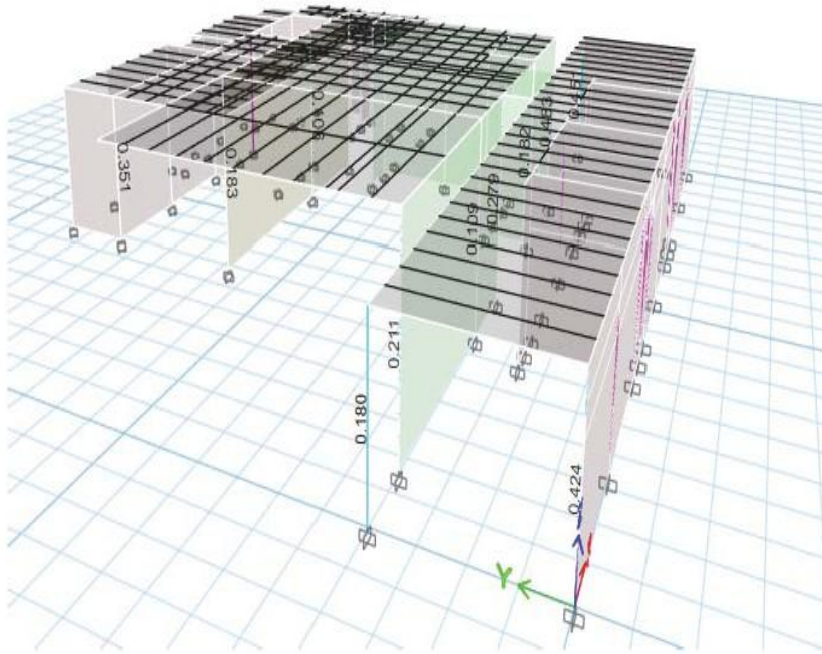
Revisión de esfuerzos en columnas, se obtienen resultados favorables para la disminución de armados en columnas C-1, C-2, C-3, C-4 y C-5. Así como los castillos K-2 y K-3.
